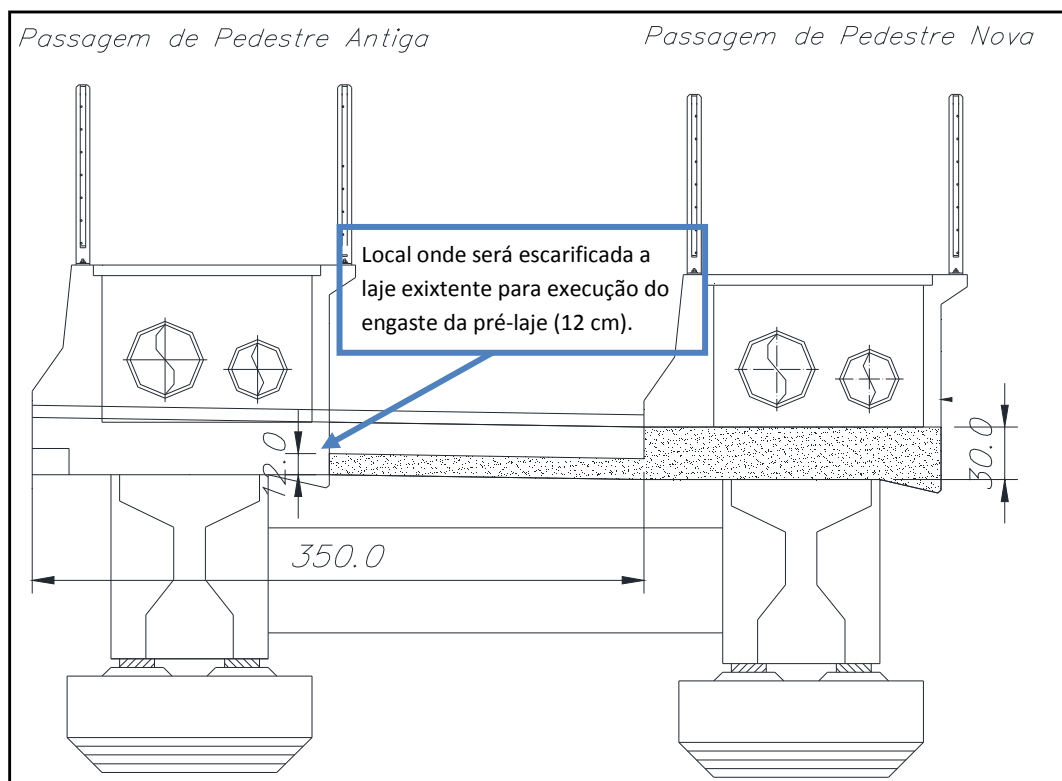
Esquema da concretagem da pré-Laje engastada na laje existente e da nova passagem de pedestre executada sobre a laje com espessura definitiva de 30 cm.
